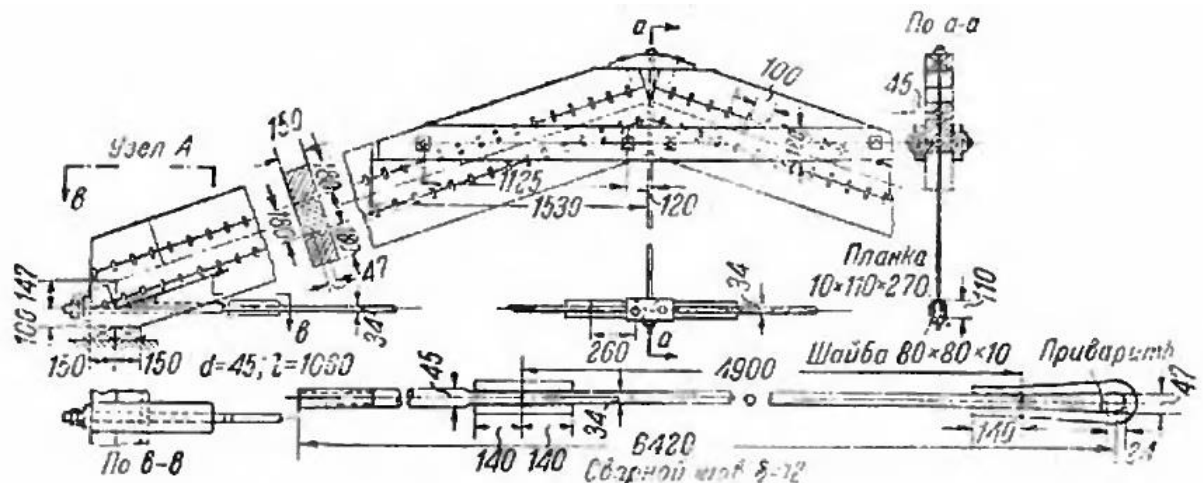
Металлодеревянная треугольная арка с верхним поясом из балок
